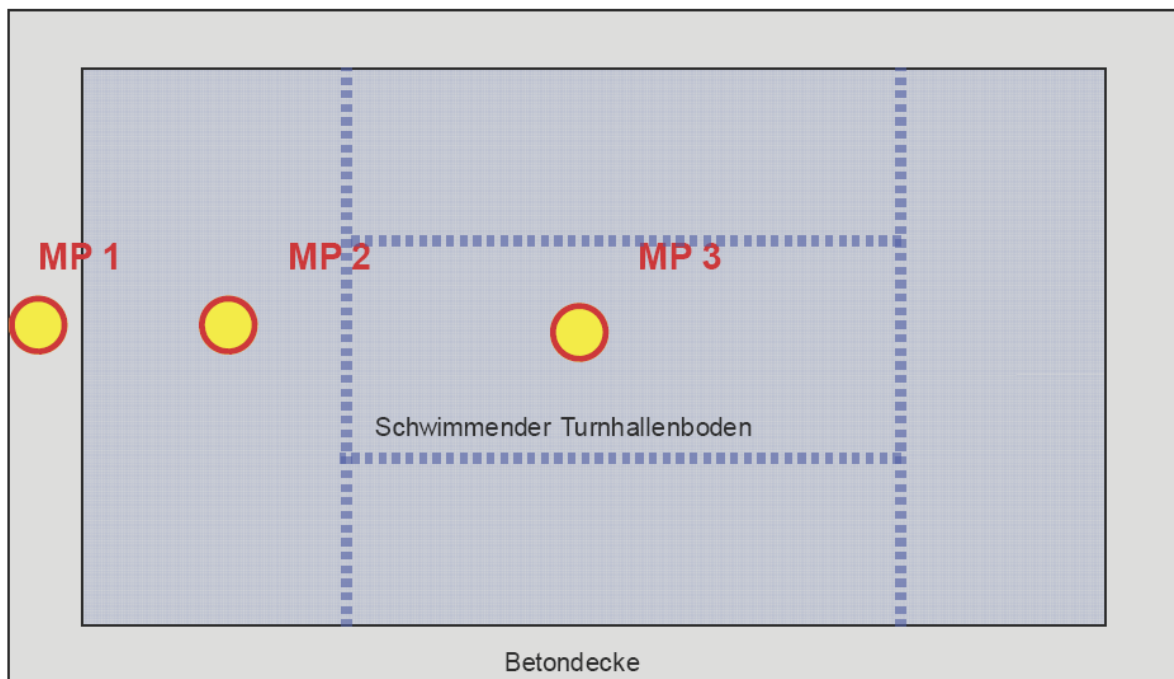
Messpunkte im Grundriss (gestrichelt: innenliegende Fachwerke im 4. OG, auf welchen die Turnhallendecke – zusätzlich zu den umlaufenden Fachwerken – direkt aufliegt)
